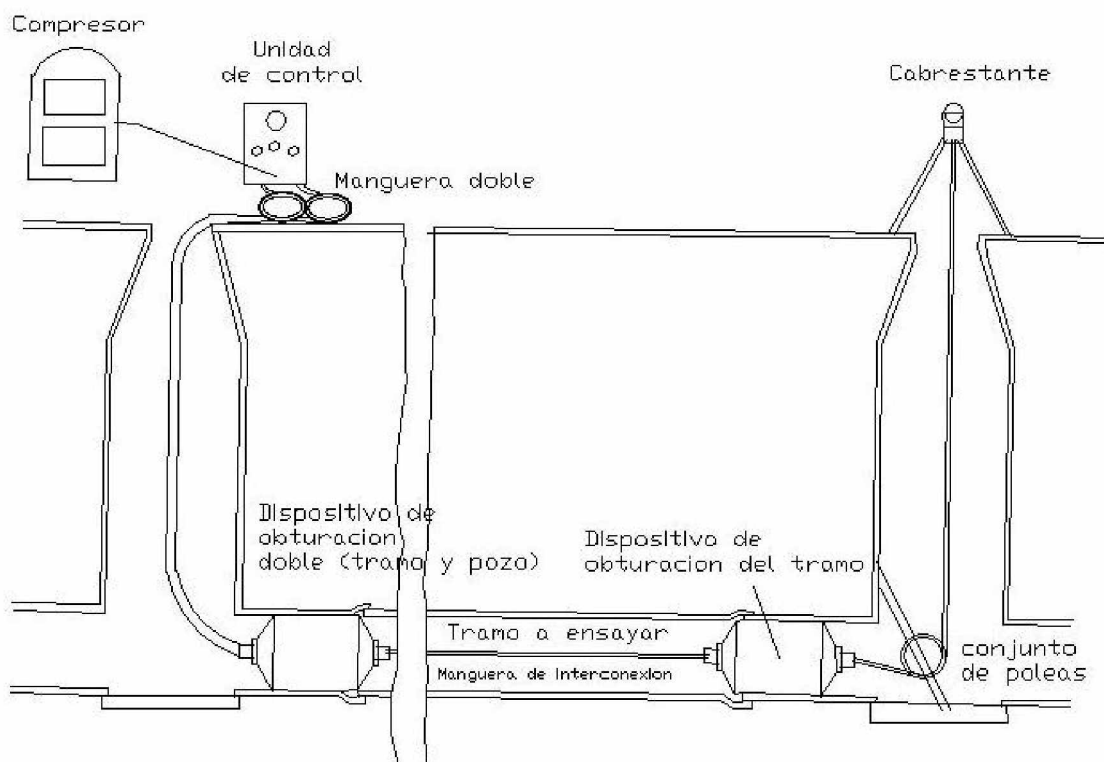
Prueba de una alcantarilla con aire a baja presión en un tramo completo entre pozos de registro
